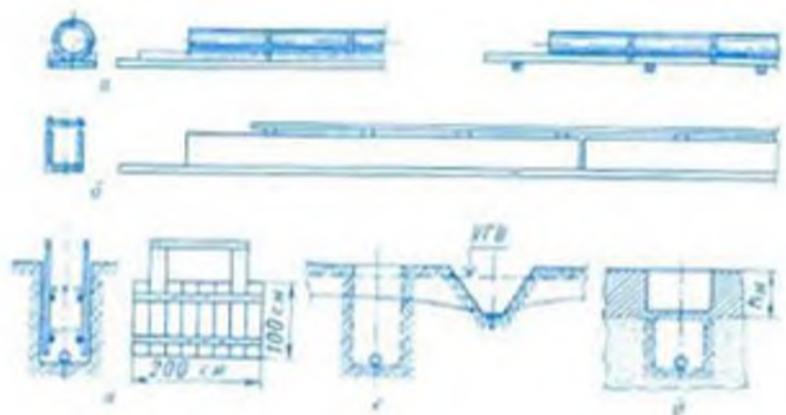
Укладка дренажных труб в неблагоприятных грунтовых условиях: а — в слабых торфяниках на деревянных стеллажах; б — в деревянные трубки из досок в грунтах с неравномерной осадкой; в — в оплывающих грунтах с креплением стенок шитами; г — при высоком уровне грунтовых вод с предварительным осушением территории открытой сетью каналов; д — в мерзлых грунтах зимой (h_m — глубина промерзания).
